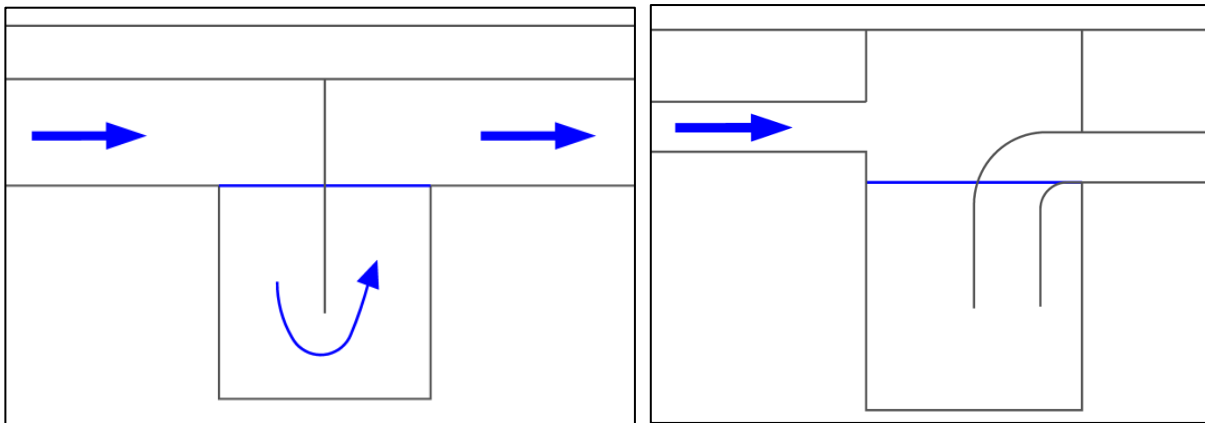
Schémas de principe de 2 exemples de zones de décantation (cloison siphonoïde et coude PVC)
